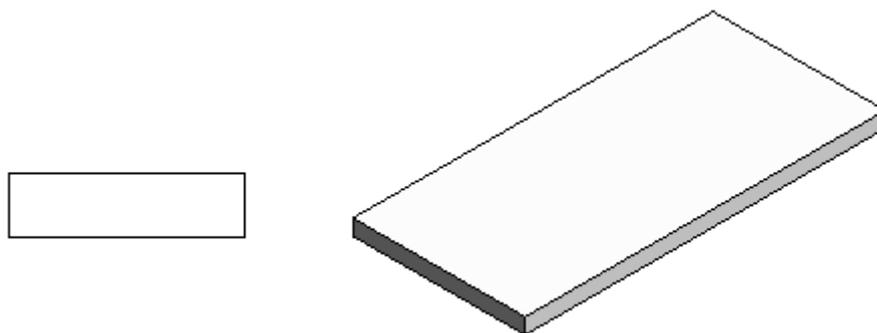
Ejemplo de muro básico de 10 cm. Imagen izquierda: Vista en planta. Imagen derecha: Vista axonométrica. Fuente: Elaboración propia. 2016.
